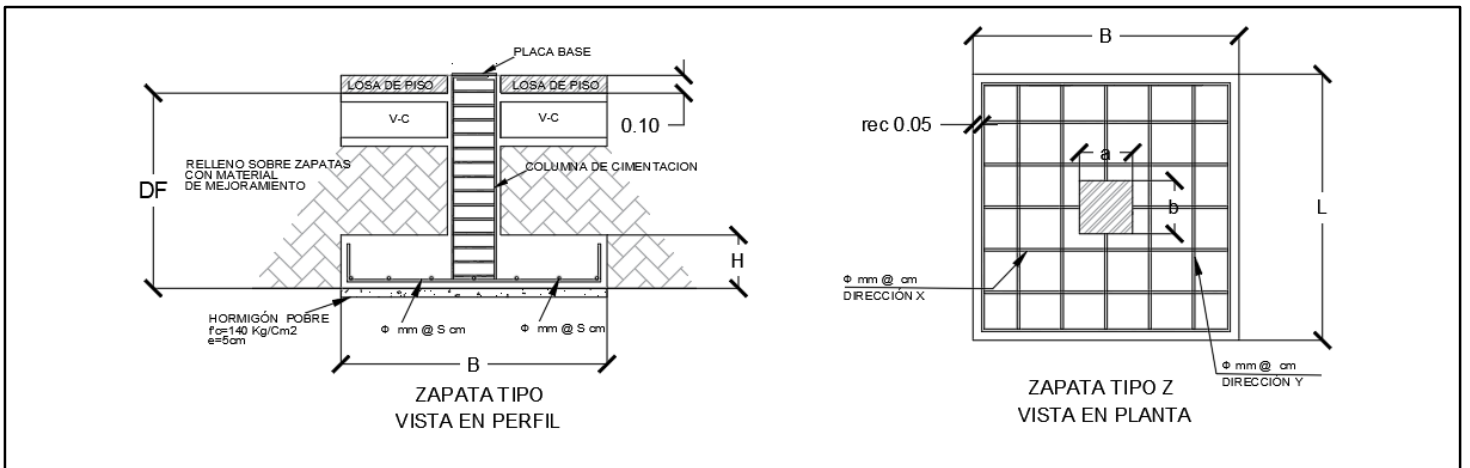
Detalle de Armadura de las Zapatas. Fuente: Nicolás Pozo
